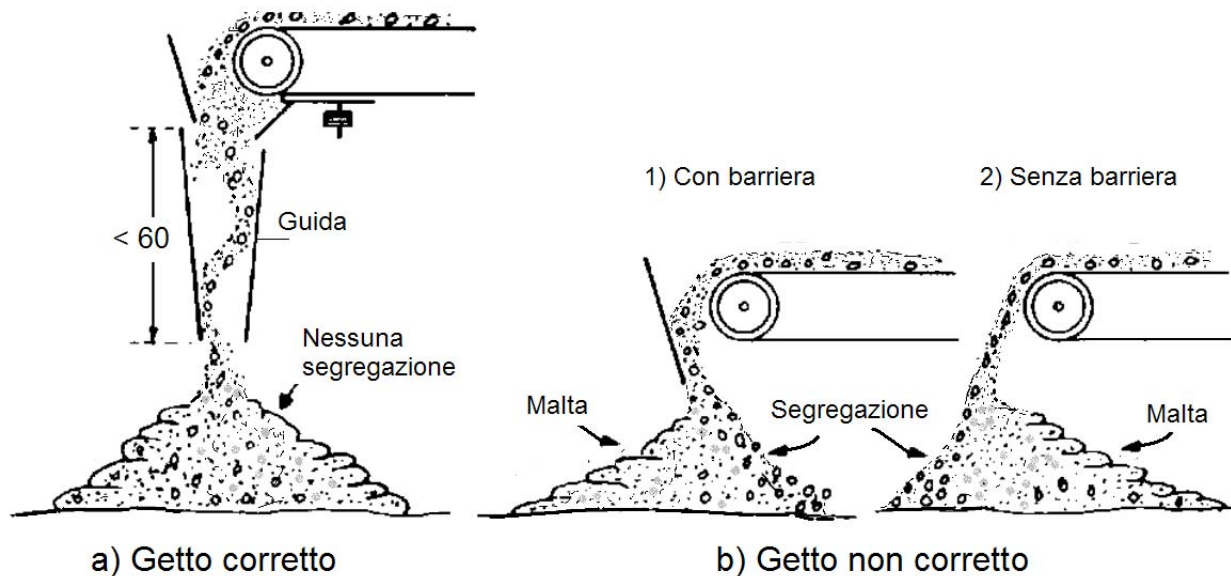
Esempi di getto di calcestruzzo con nastro trasportatore: a) getto corretto e b) getto non corretto. Nel caso b) si ha la separazione degli aggregati dalla malta cementizia. La barriera comporta soltanto il cambiamento di direzione della segregazione.
